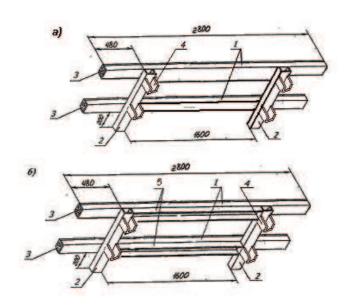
а) – торцевой щит; б) – усиленный щит 1 – балка, 2 – стойка; 3 – брусок, 4 – направляющая; 5 – швеллер
